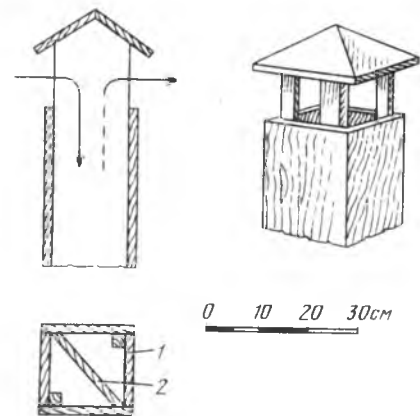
Вентиляционная шахта с использованием ветроулавливания:
